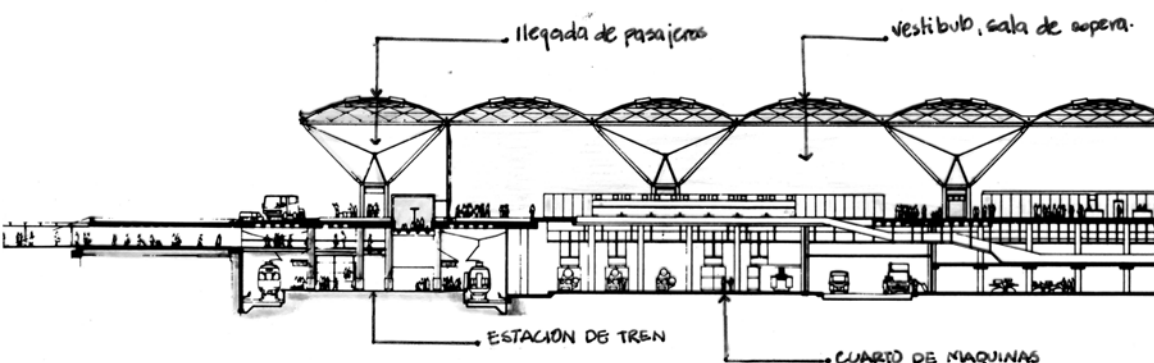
Corte esquemático aeropuerto Stansted
